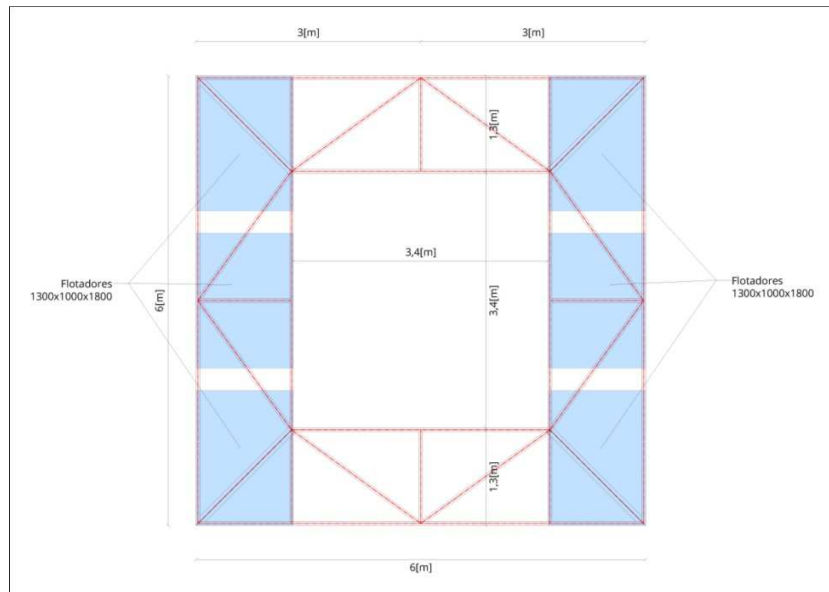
Estructura de acero. FUENTE: Elaboración propia.
